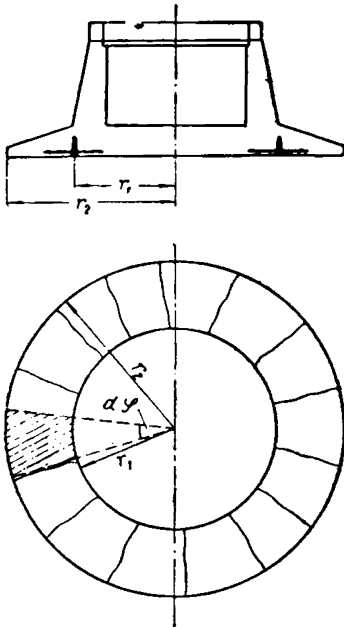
Схема разрушения нижней плиты фундамента с образованием цилиндрической трещины
